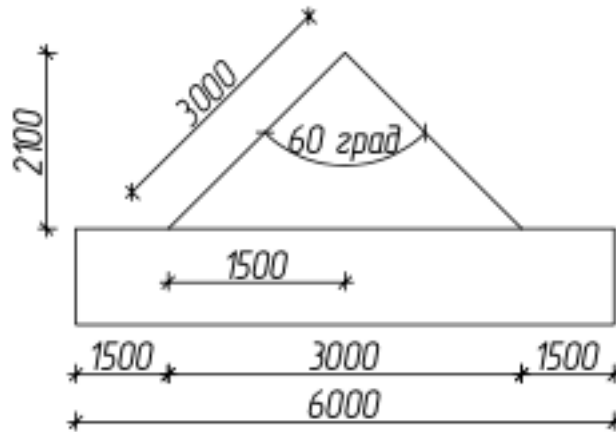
Расчет длины двухветвевго стропы для монтажа пучков арматуры и опалубки
